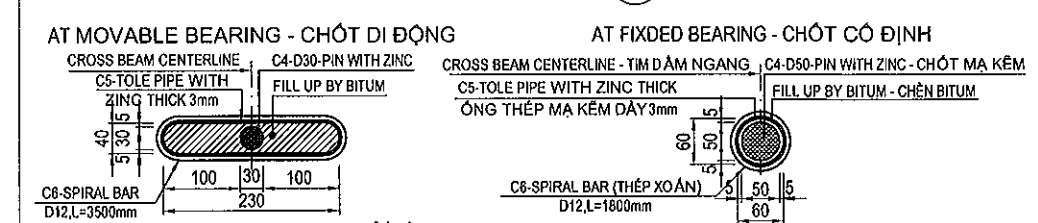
## DETAIL ANTI COLLIDING - CHI TIẾT Ự CHÔNG XÔ
